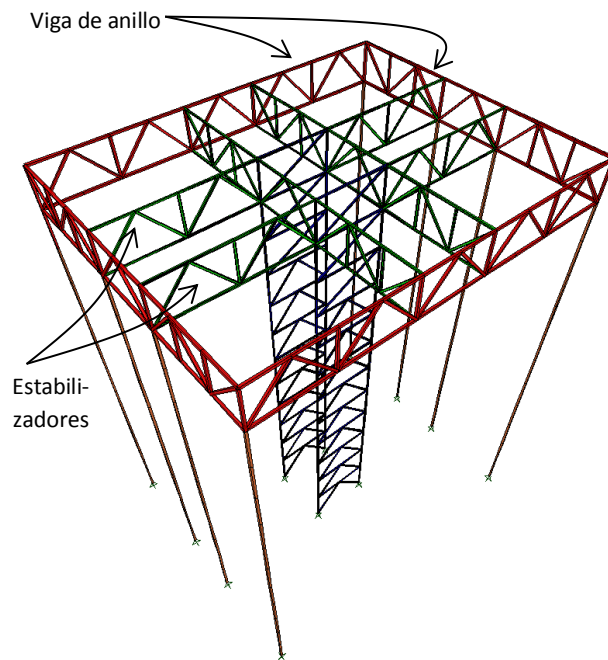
Estructura con núcleo central con brazos laterales y viga de anillo para conectar con las columnas periféricas.
